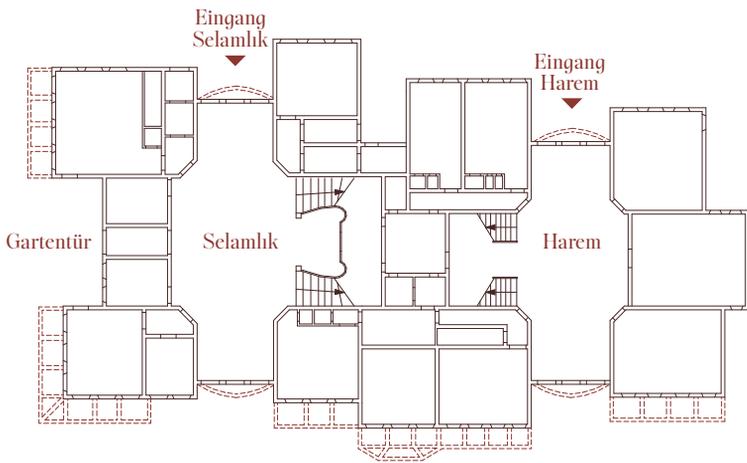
Grundriss Erdgeschoss des Yasinci-Hauses in Anadolu Hisari, Istanbul
